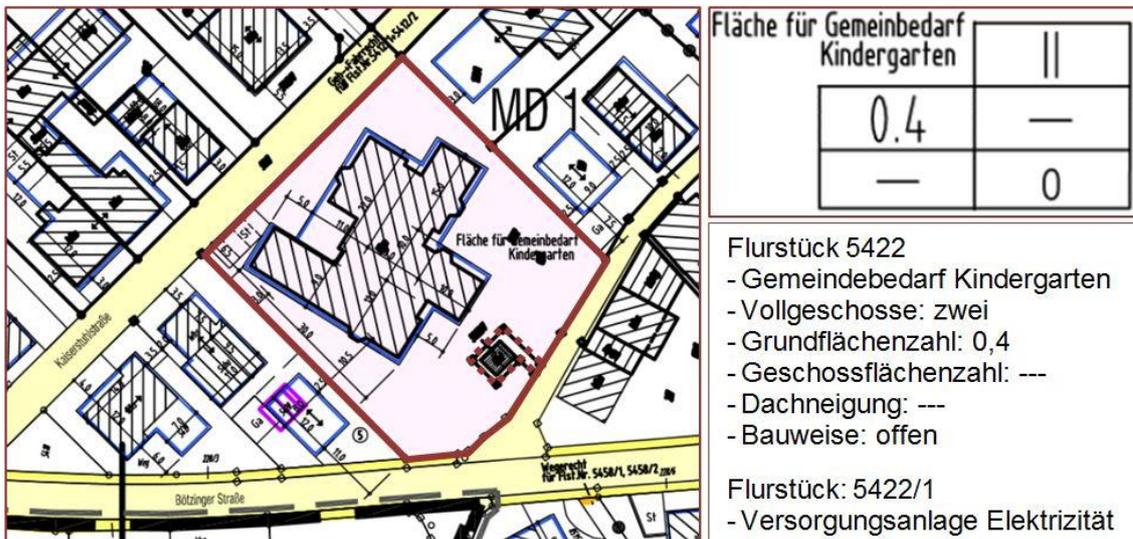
Bebauungsplan Gottenheim Oberdorf (Gemeinde Gottenheim)¹⁸⁷
